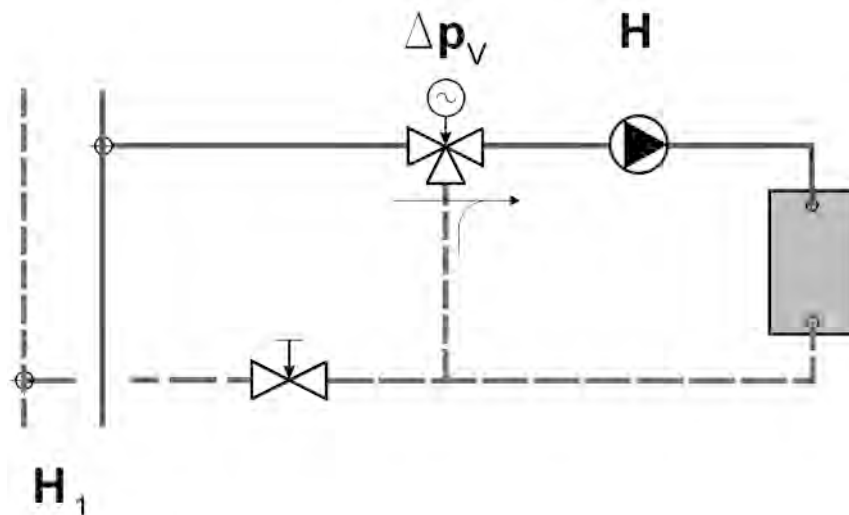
Trojcestný ventil zaťažený tlakom z primárnej časti so spätnou klapkou
